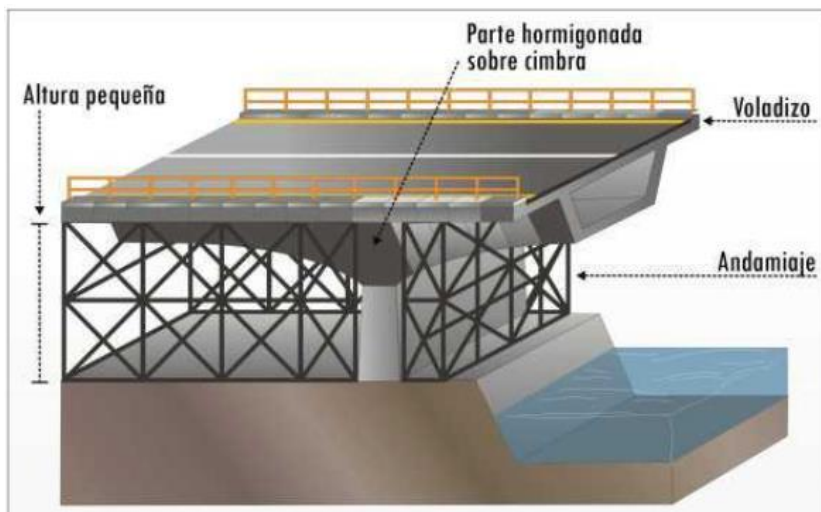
Construcción con tramo lateral hormigoneado sobre cimbra.
